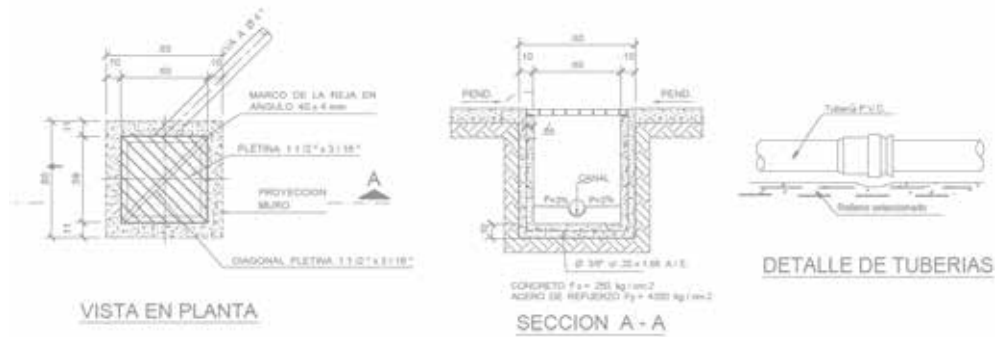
Detalle de tramado de local de venta Fuente: La Autora (2021)
